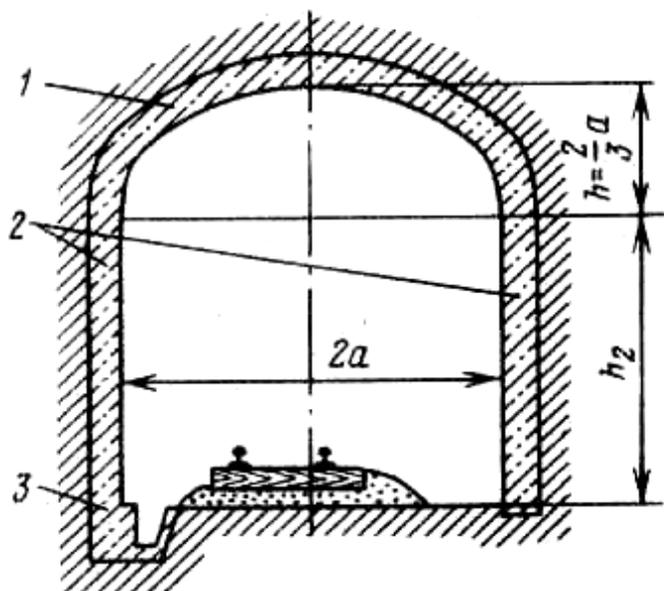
Выработка с Коробовым сводом, закрепленная бетонной крепью: 1 — свод; 2 — стенки; 3 — фундамент; а — полупролет ширины выработки;  $h_2$
